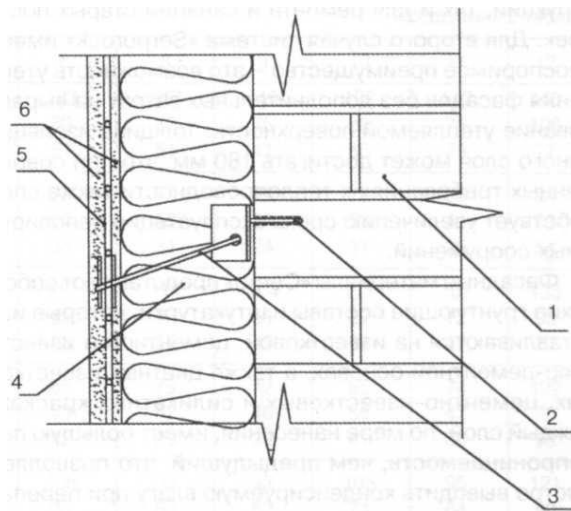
Конструкція утеплення стіни «мокрого» типу з цементно-піщаною штукатуркою і кріпленням теплоізоляційного шару гнучкими (рухливими) анкерами : 1 – несуча стіна; 2, 3 - елемент кріплення;
